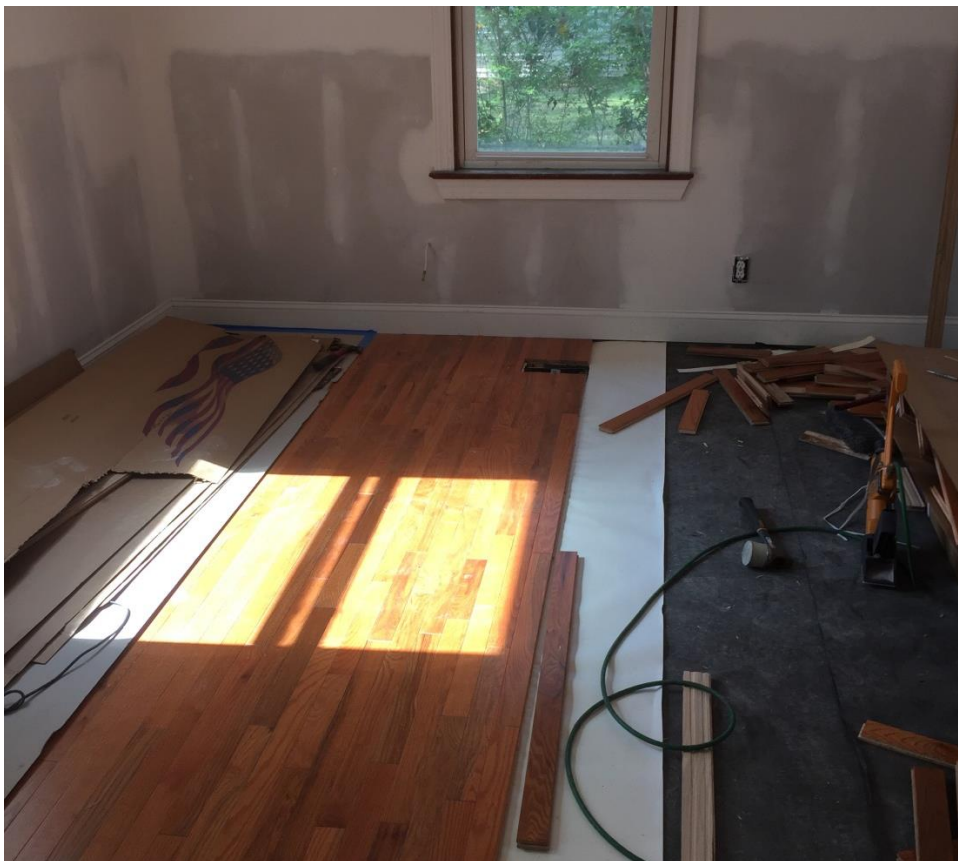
Lamina impermeabilizante sobre mastico en piso.
